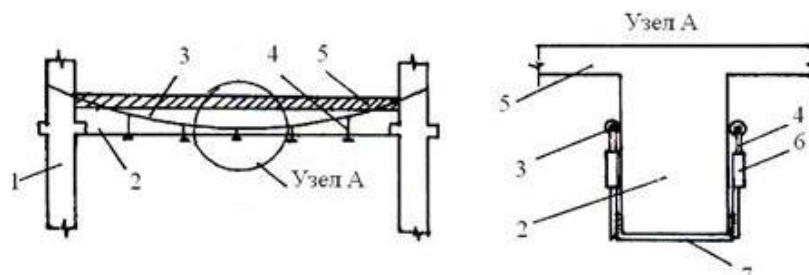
Усиление балок монолитного перекрытия шпренгелем с подвесками
